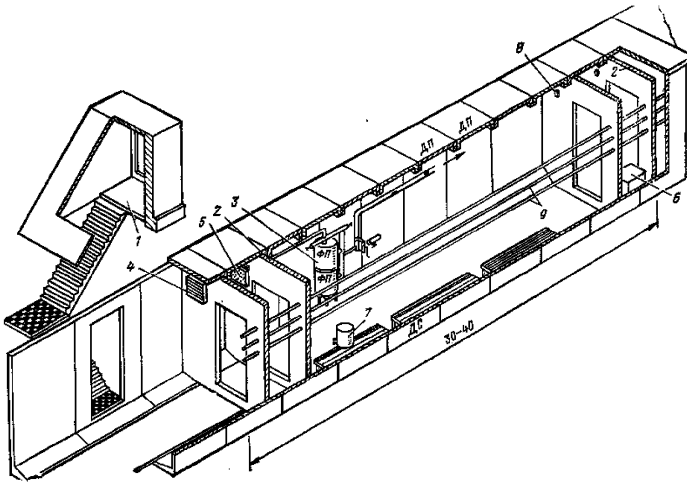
Приспособление общего коллектора под убежище:
